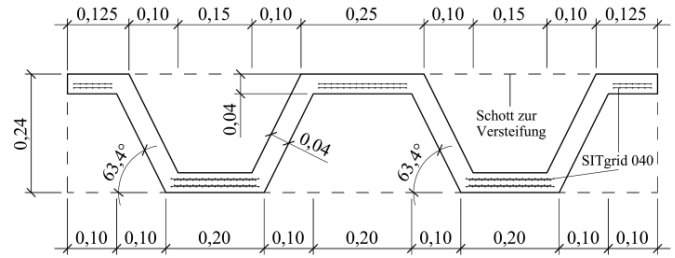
Trapezplattenquerschnitt (Abmessungen in m)
